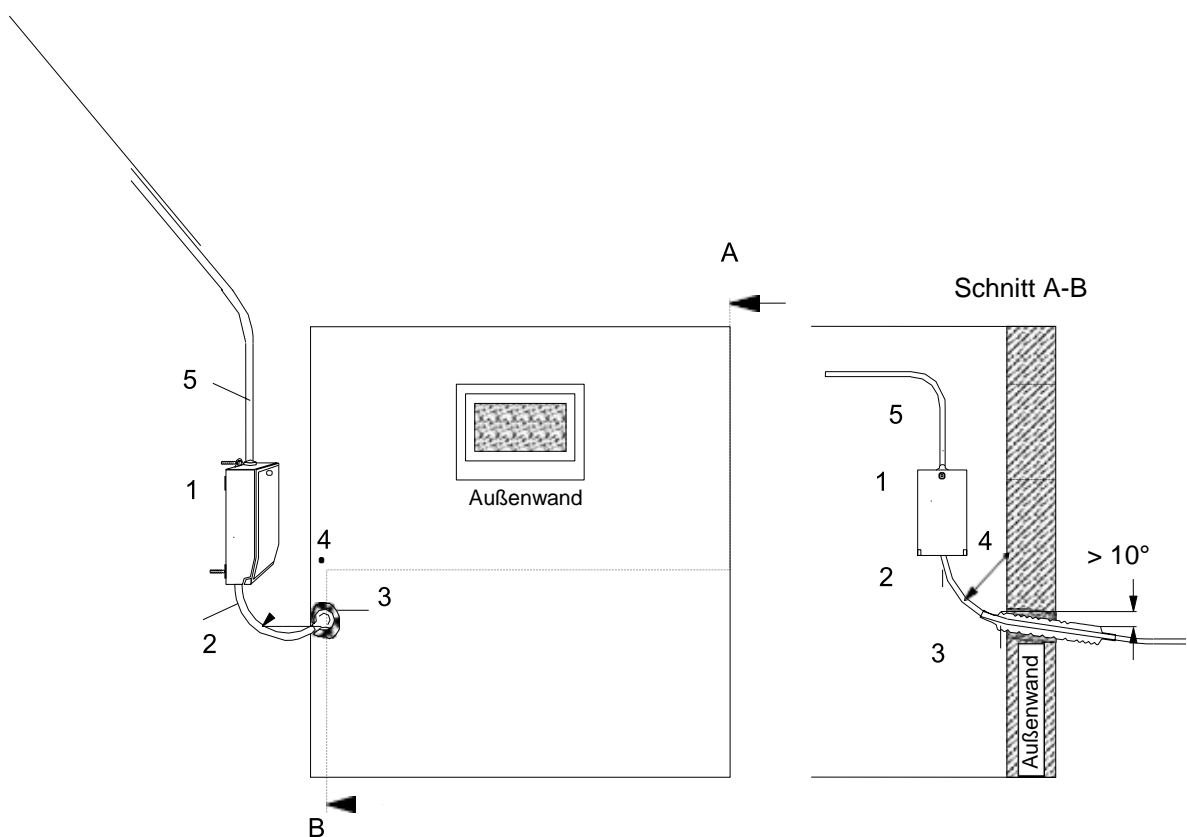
Beispiel für einen Kabel-Netzanschluss, Innenanschlusstechnik
